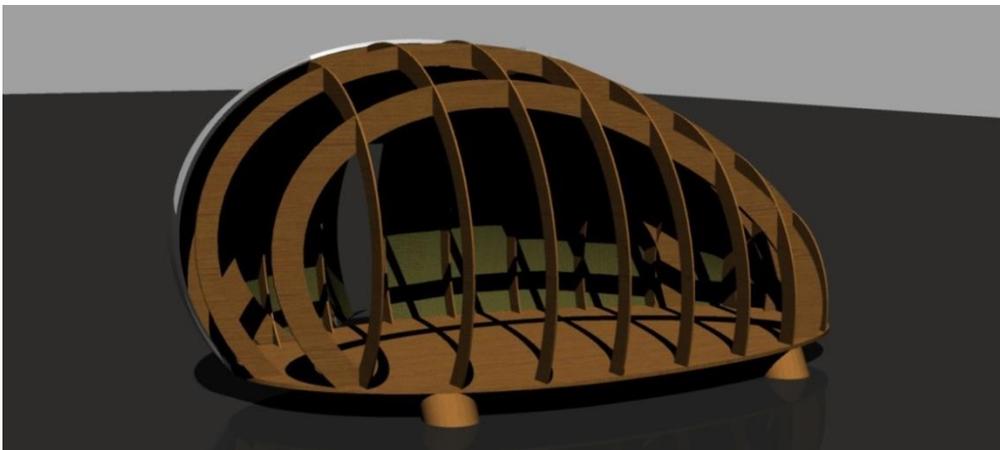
| Visualização 3D do conjunto estrutural do módulo final.
